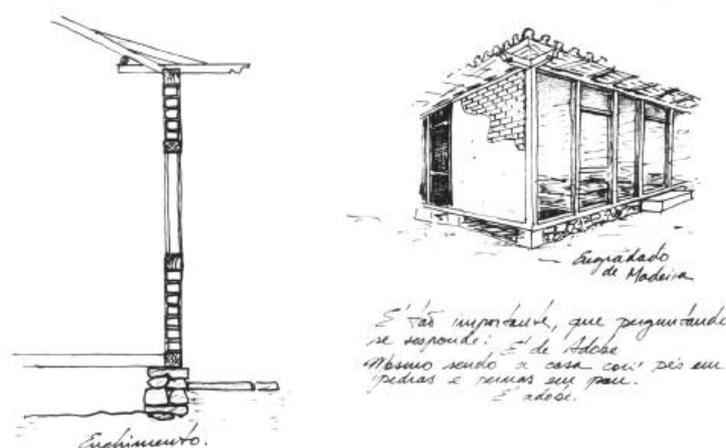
Adobe construído sobre a técnica de painéis divisórios.
